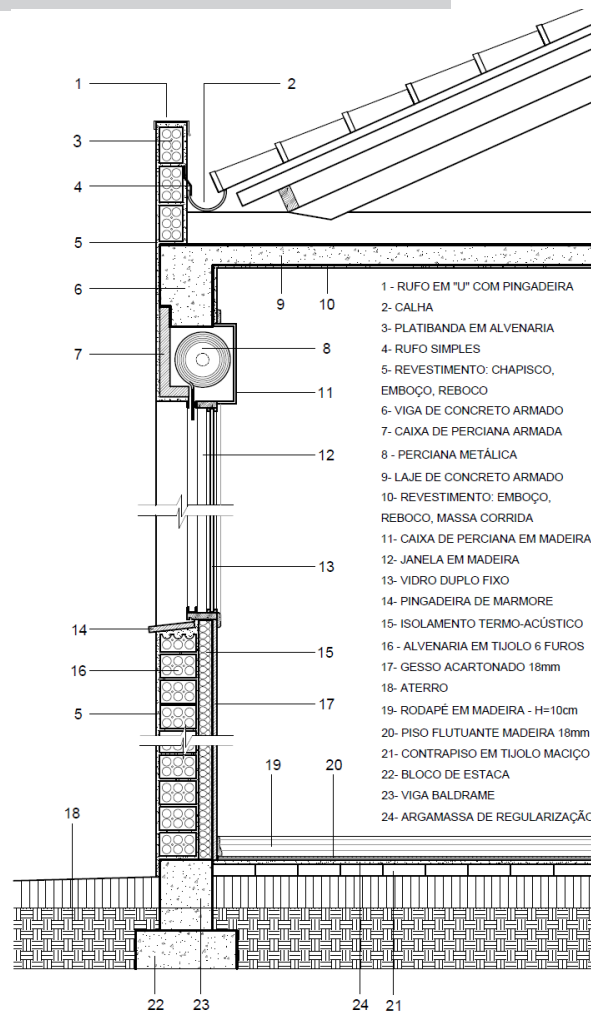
Exemplo de detalha de uma fachada em corte (corte de pele). Fonte: autor
